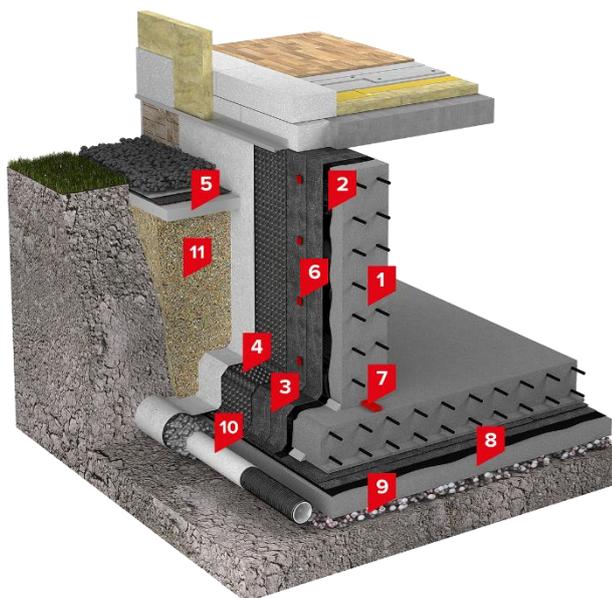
Конструктивное решение подземной части здания с ленточным фундаментом:
